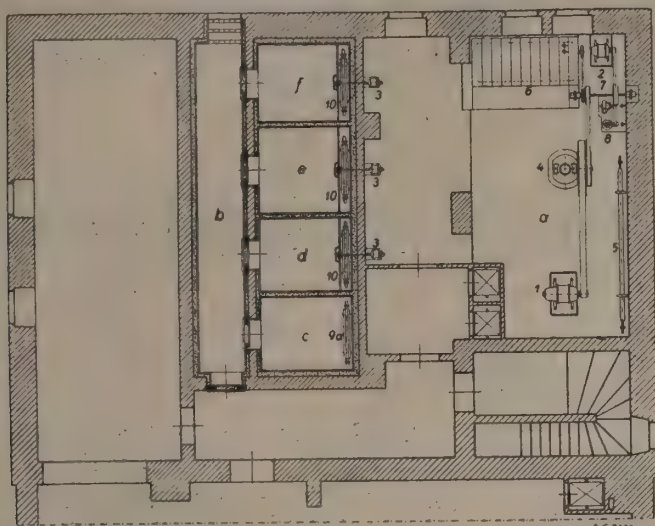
Grundriß durch eine Astra-Kühlanlage.
